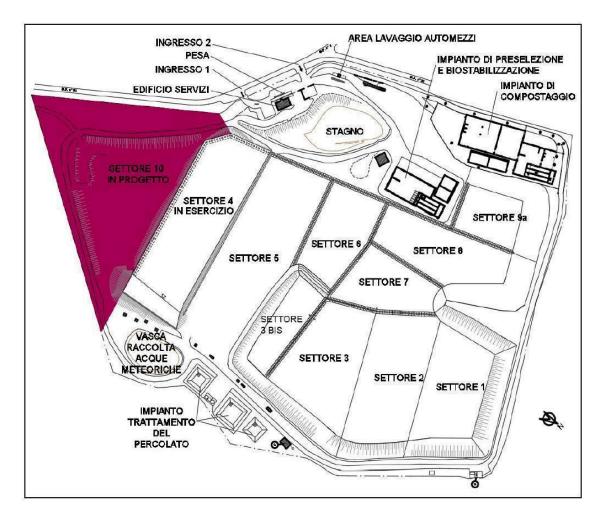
Planimetria generale impianto con indicati singoli settori e area destinata alla realizzazione del Modulo 10
